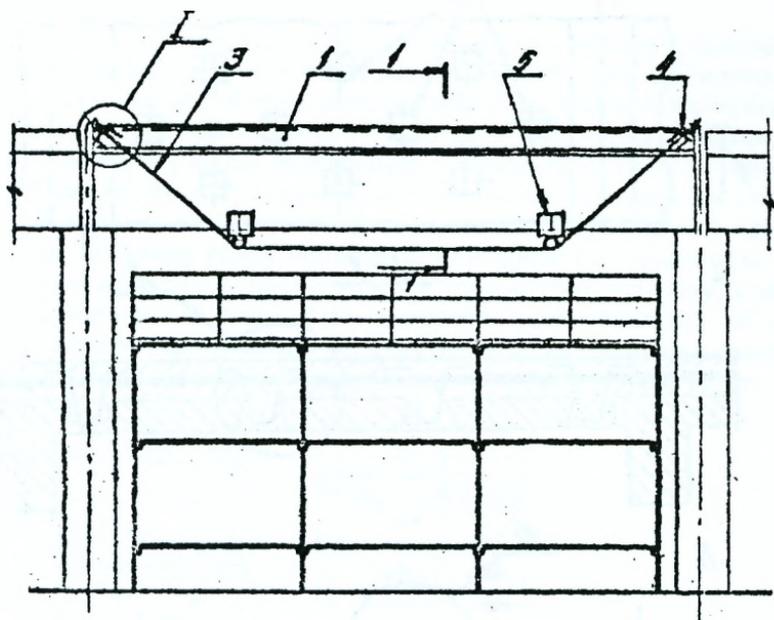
Схема усиления подкрановых балок шпренгельной затяжкой с креплением к обойме полки:
